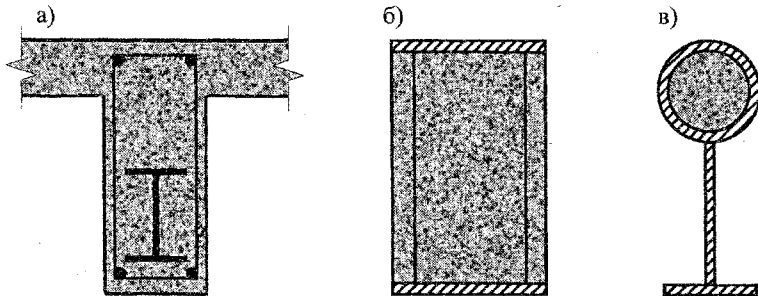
Поперечні перерізи сталезалізобетонних балок і ригелів:
